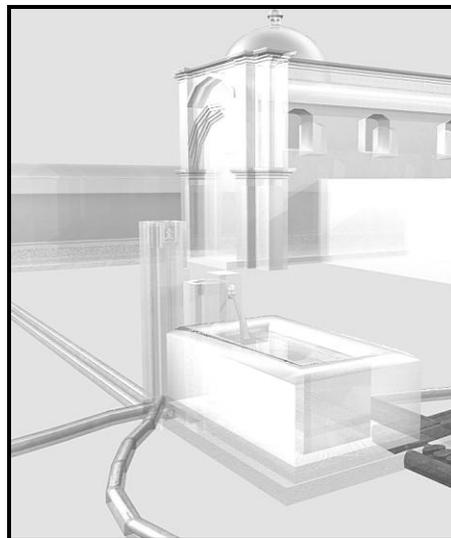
Detalle dimensional del funcionamiento entre la columnaria y la pila. A. Ibáñez/J. Cáceres.
